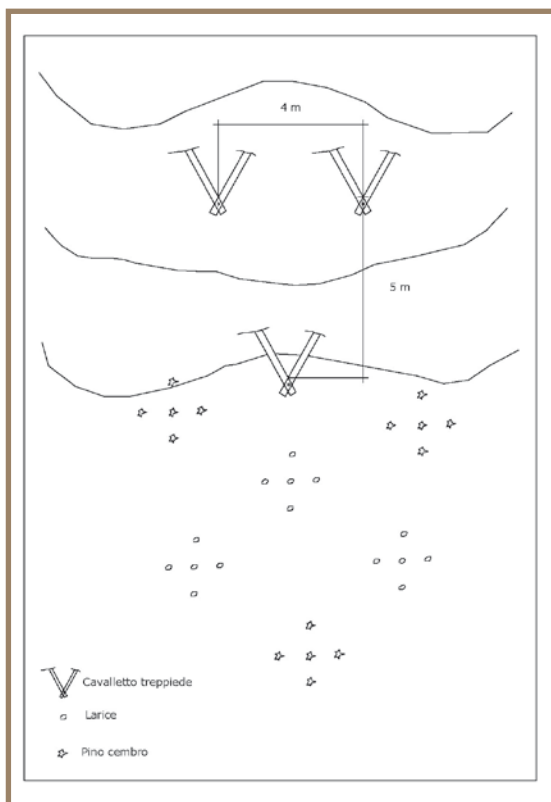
Schema di impianto per collettivi protetto da cavalletti treppiede
